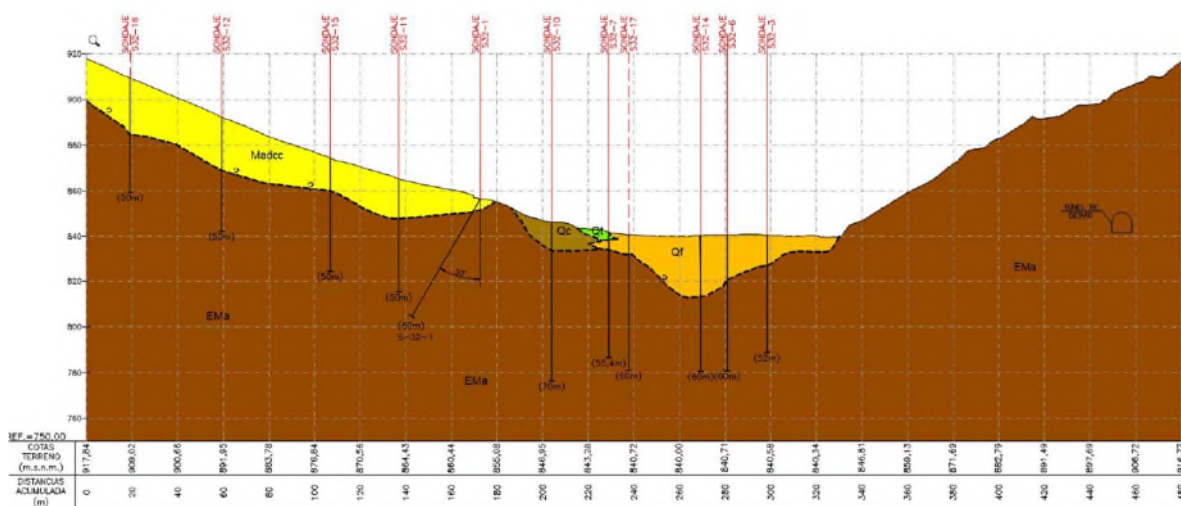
Ubicación Sitio 3 donde se visualiza alta pendiente en Estribo Derecho
